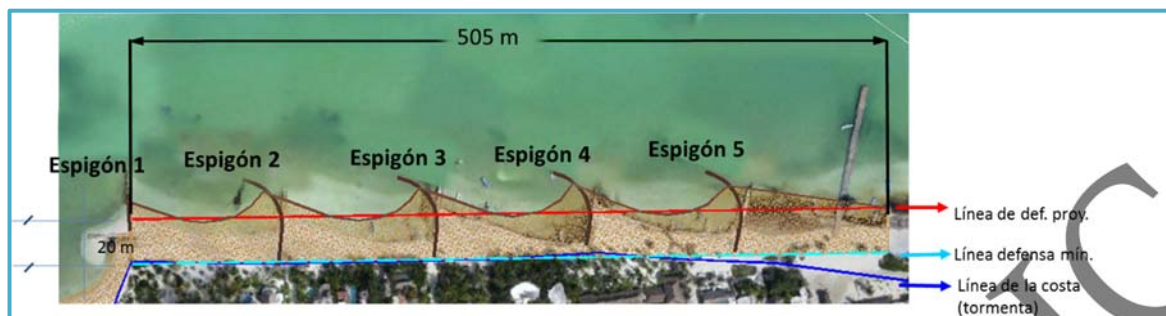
Arreglo en planta de toda la zona de protección Centro con espigones.
